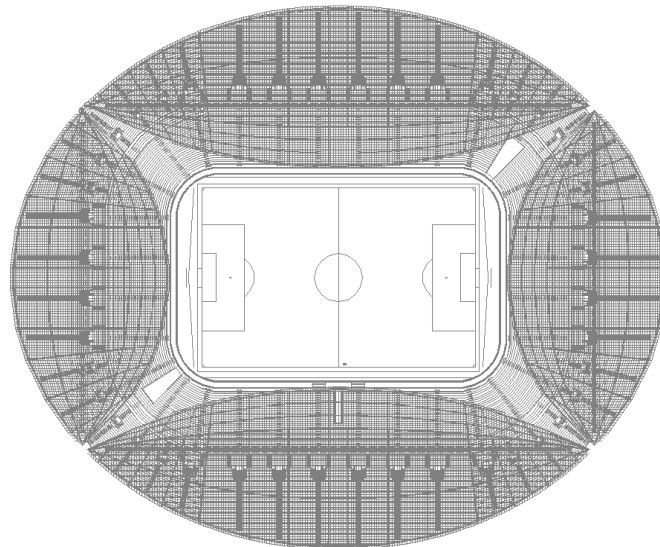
Planta de coberturas do Estádio da Luz
